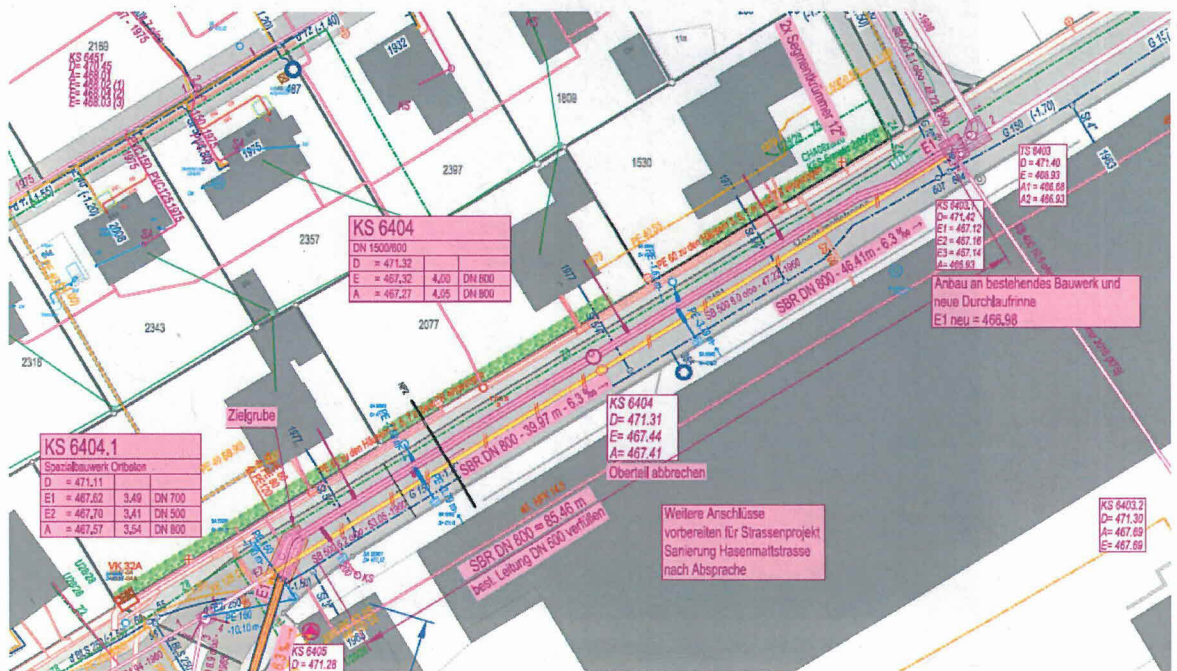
Ausschnitt Situationsplan Bauprojekt
